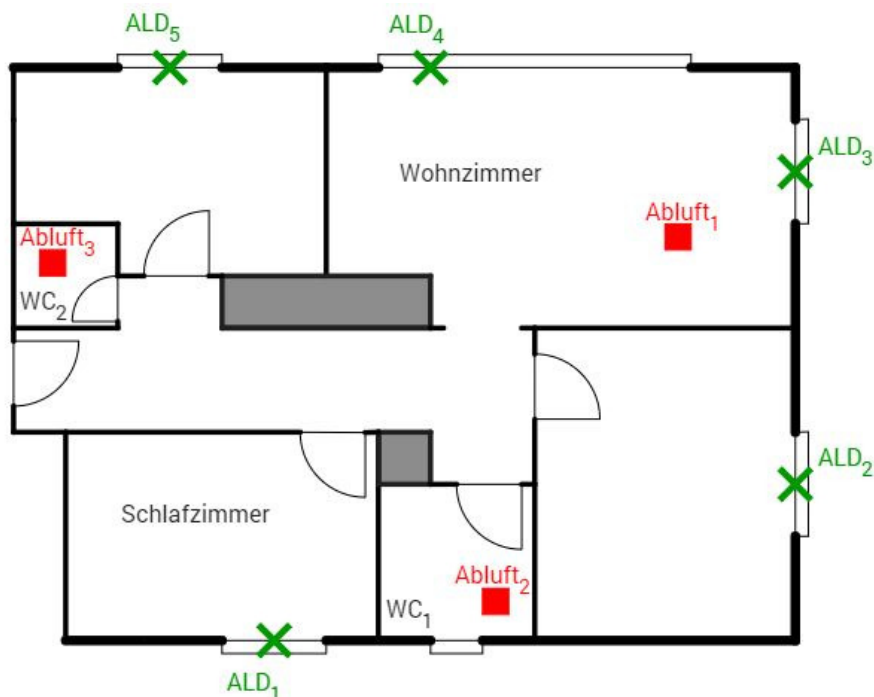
schematischer Grundriss der Wohnung in Oberwenigen mit Zu- und Abluftstellen
